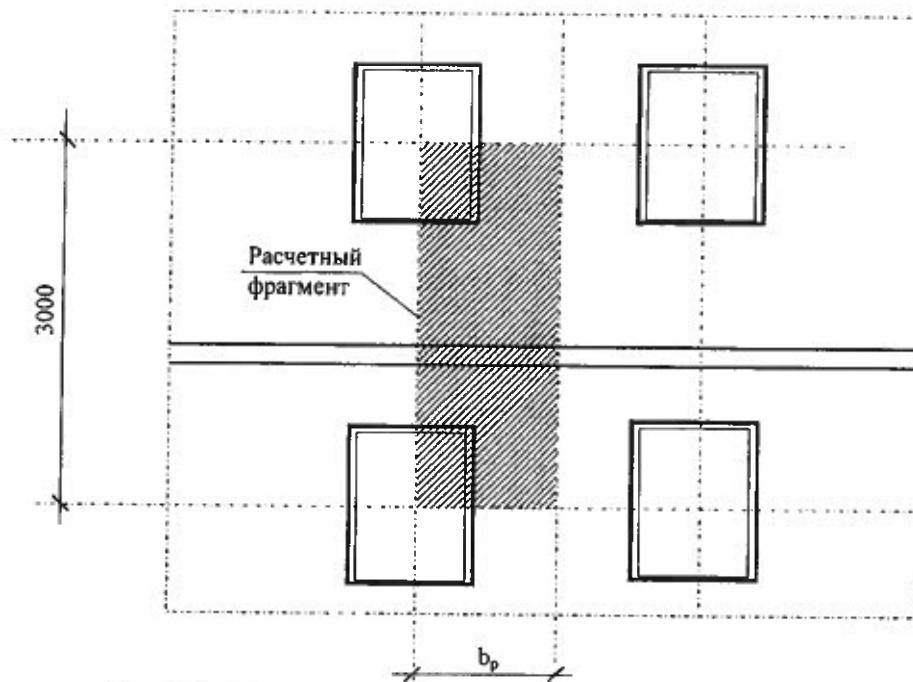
Расчетная схема фрагмента наружной стены здания для определения приведенного сопротивления теплопередаче участка с оконными проемами (вид со стороны помещения)
